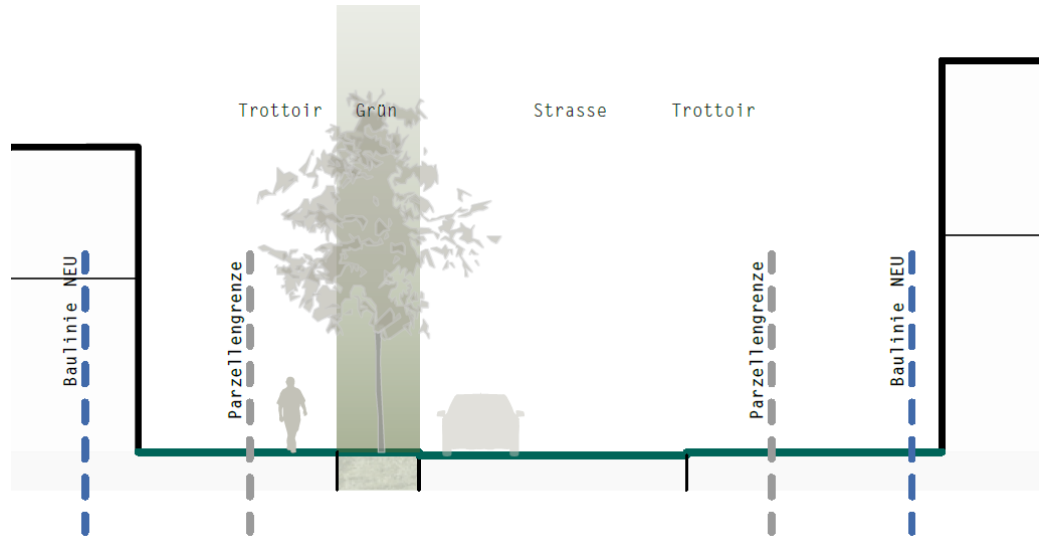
Prinzipschnitt Fabrikstrasse mit Baumreihe (Westpol Landschaftsarchitekten)
